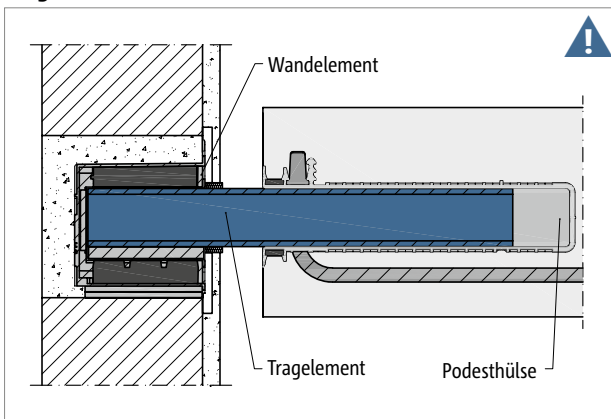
Schöck Tronsole® Typ P: Mehrteiliges Produkt (Wandelement, Tragelement, Podesthülse); Tragelement (eingefärbt) muss auf der Baustelle eingebaut werden.
